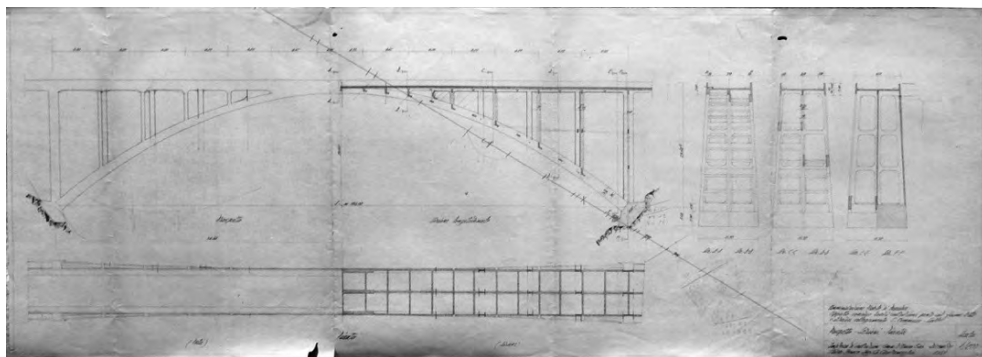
Ing. G. Cantamaglia: ponte di Salle, prospetto-sezione e pianta, con i “portali”, scala 1:200.
